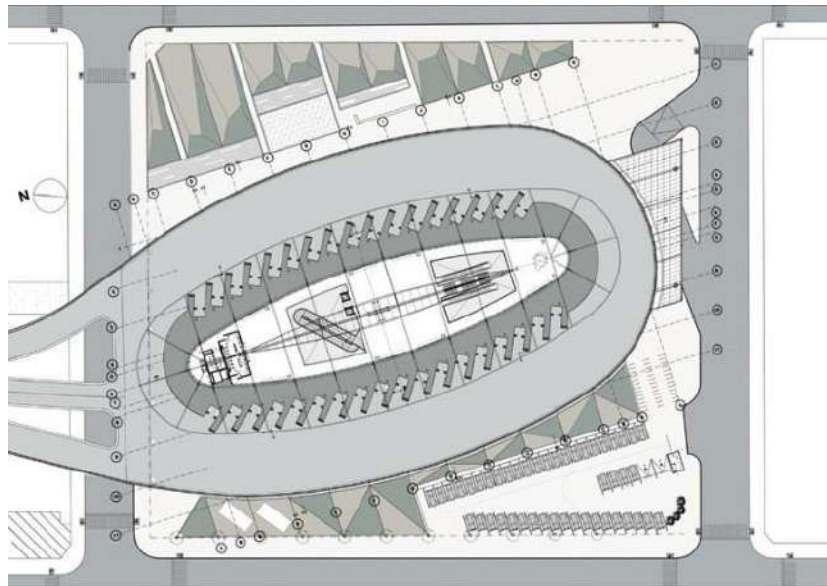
Distribución arquitectónica del terminal terrestre de pasajeros Santiago del Estero.
